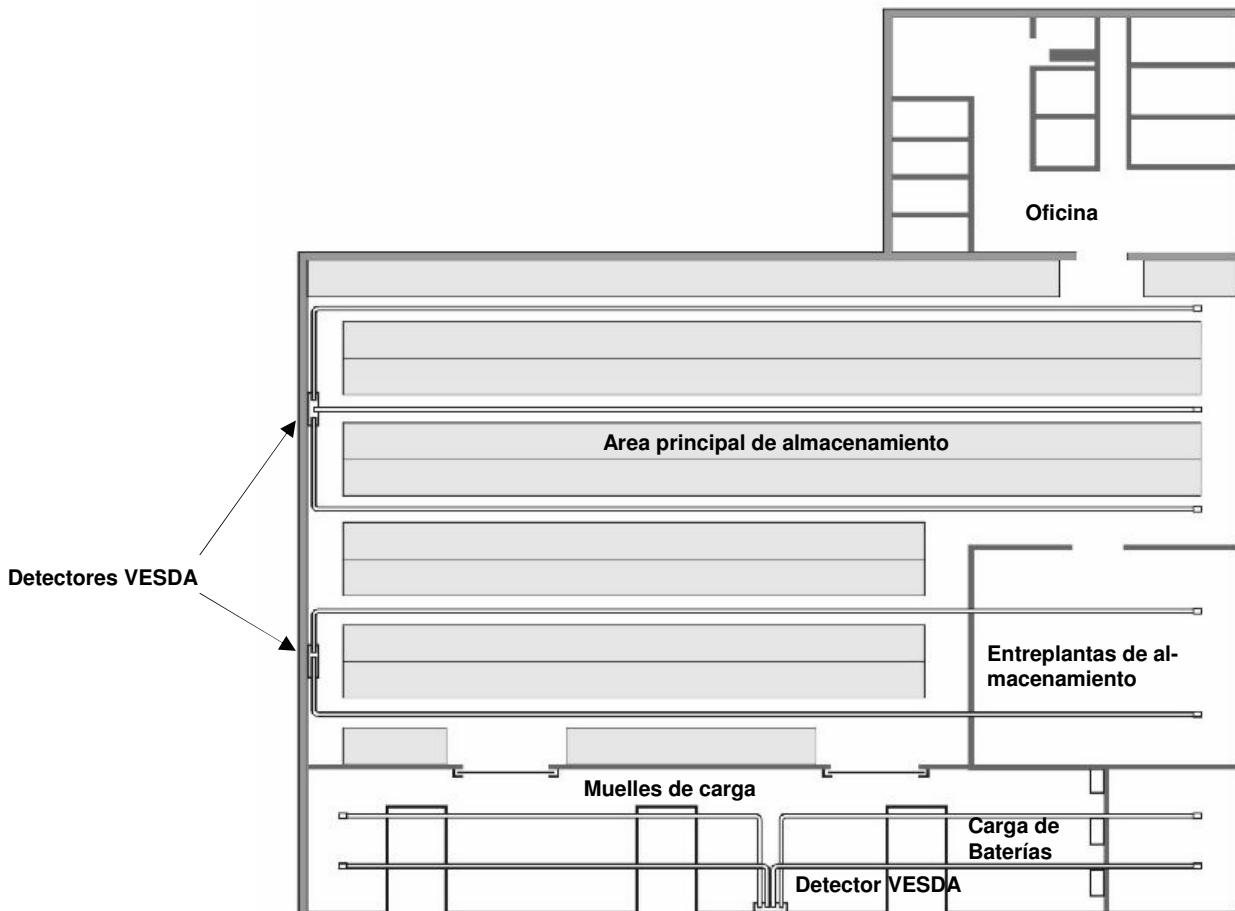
Planta de un almacén – Configuración de tubos instalados bajo cubierta
